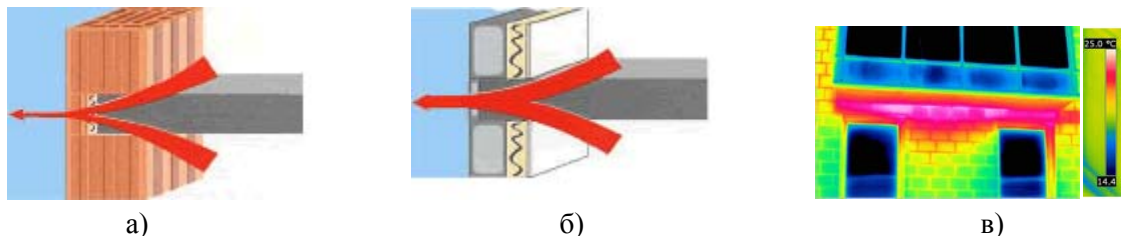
Опирание плиты перекрытия на несущую наружную стену здания а) со слоем утеплителя; б) без слоя утеплителя; в) термограмма
